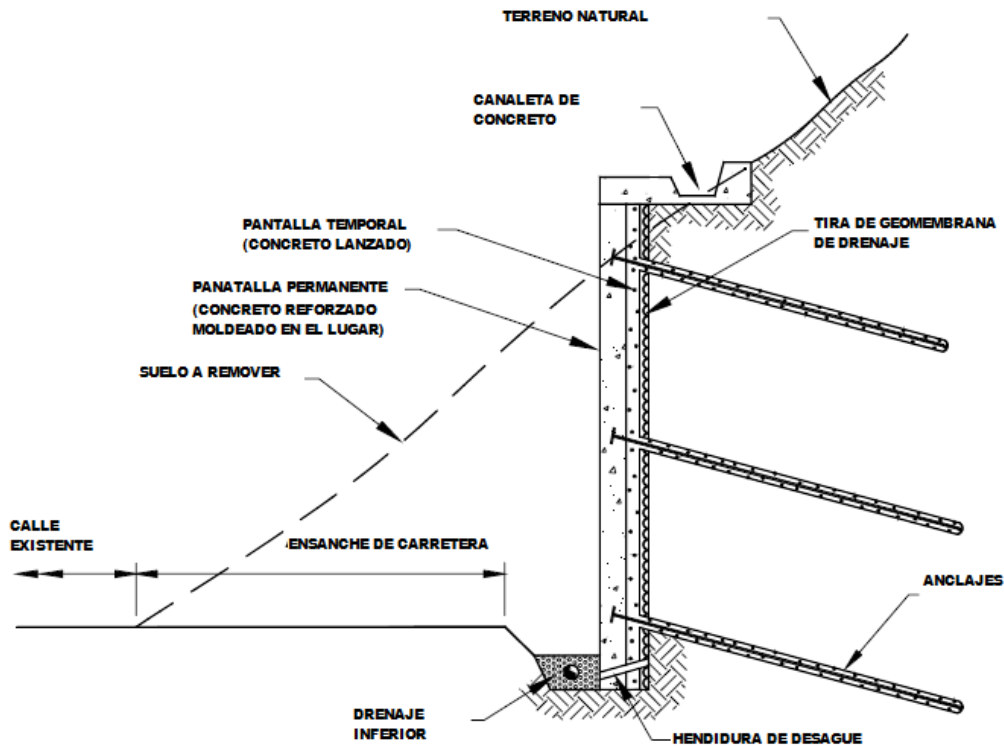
5 Muro de soil nailing en ensanche de carreteras.
